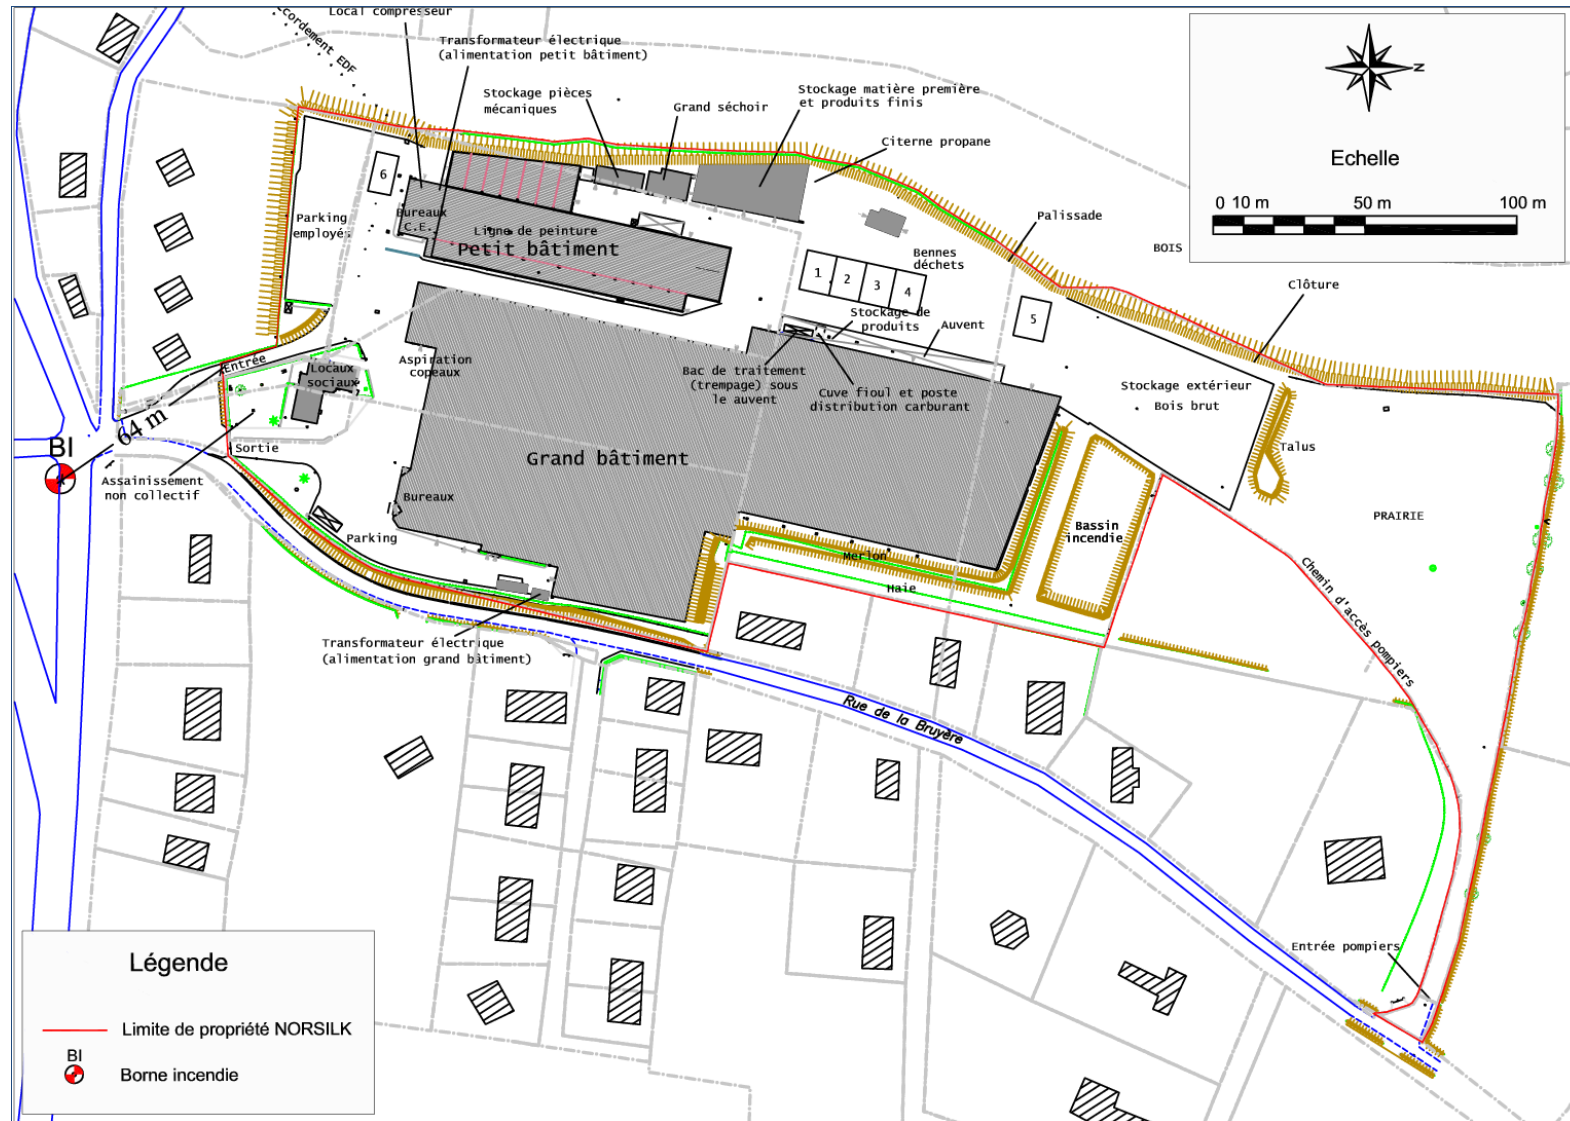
Plan de localisation des bornes incendie situées à l'extérieur
